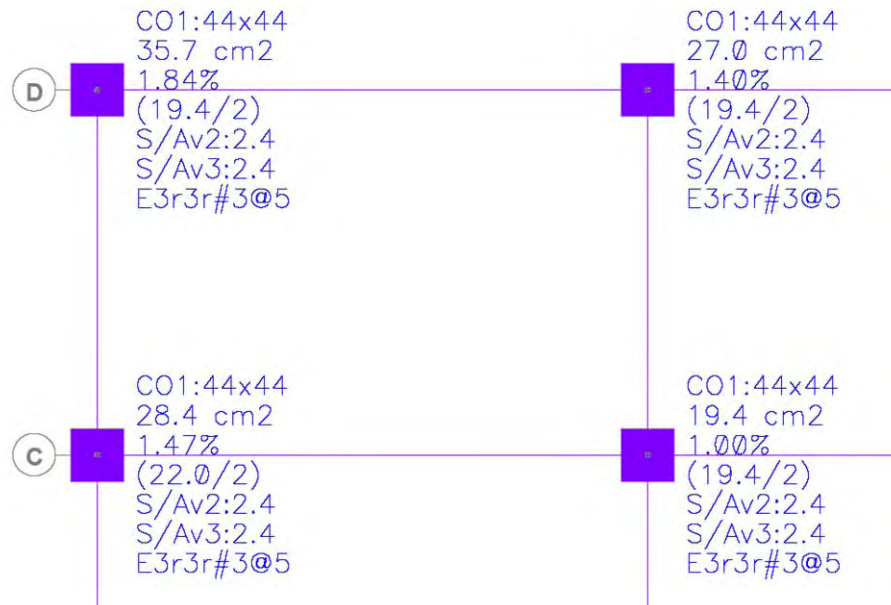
Características detalladas de los aceros de refuerzo longitudinal y transversal en algunas columnas del nivel 1 del edificio de 7 niveles.
